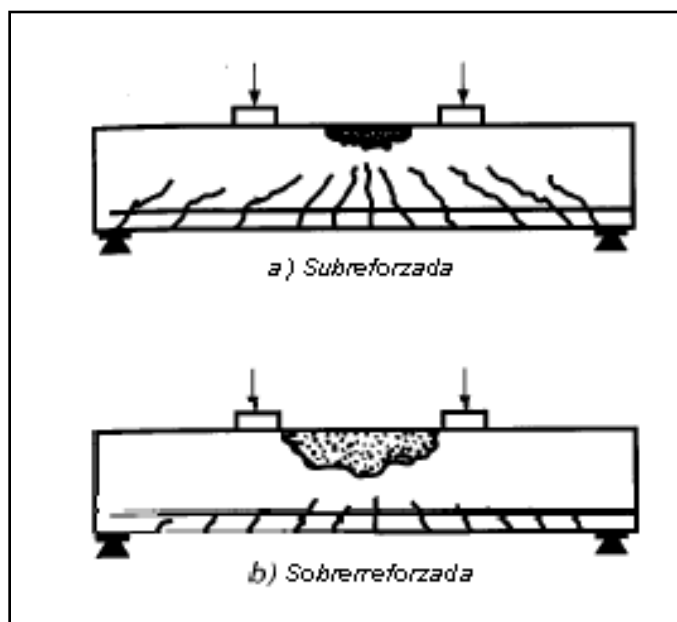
Agrietamiento en la falla de vigas sujetas a flexión. Fuente: González Cuevas & Robles Fernández, (2005).
